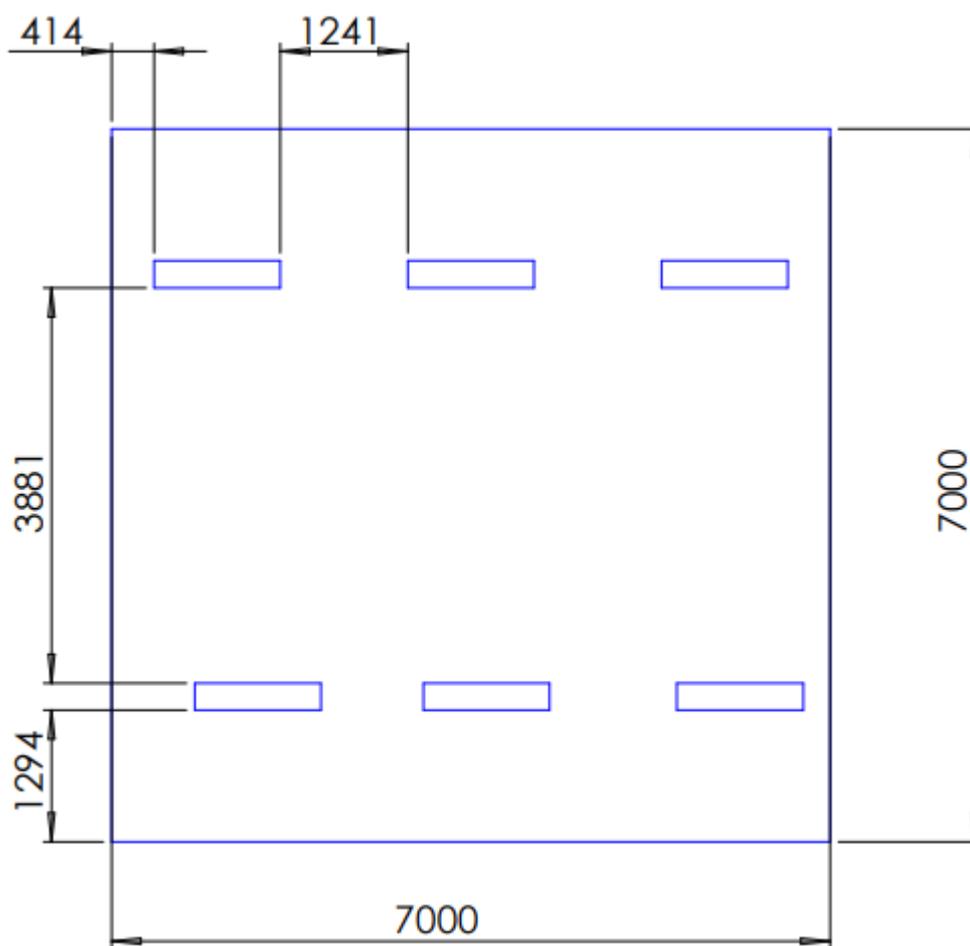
План размещения светильников на потолке.
